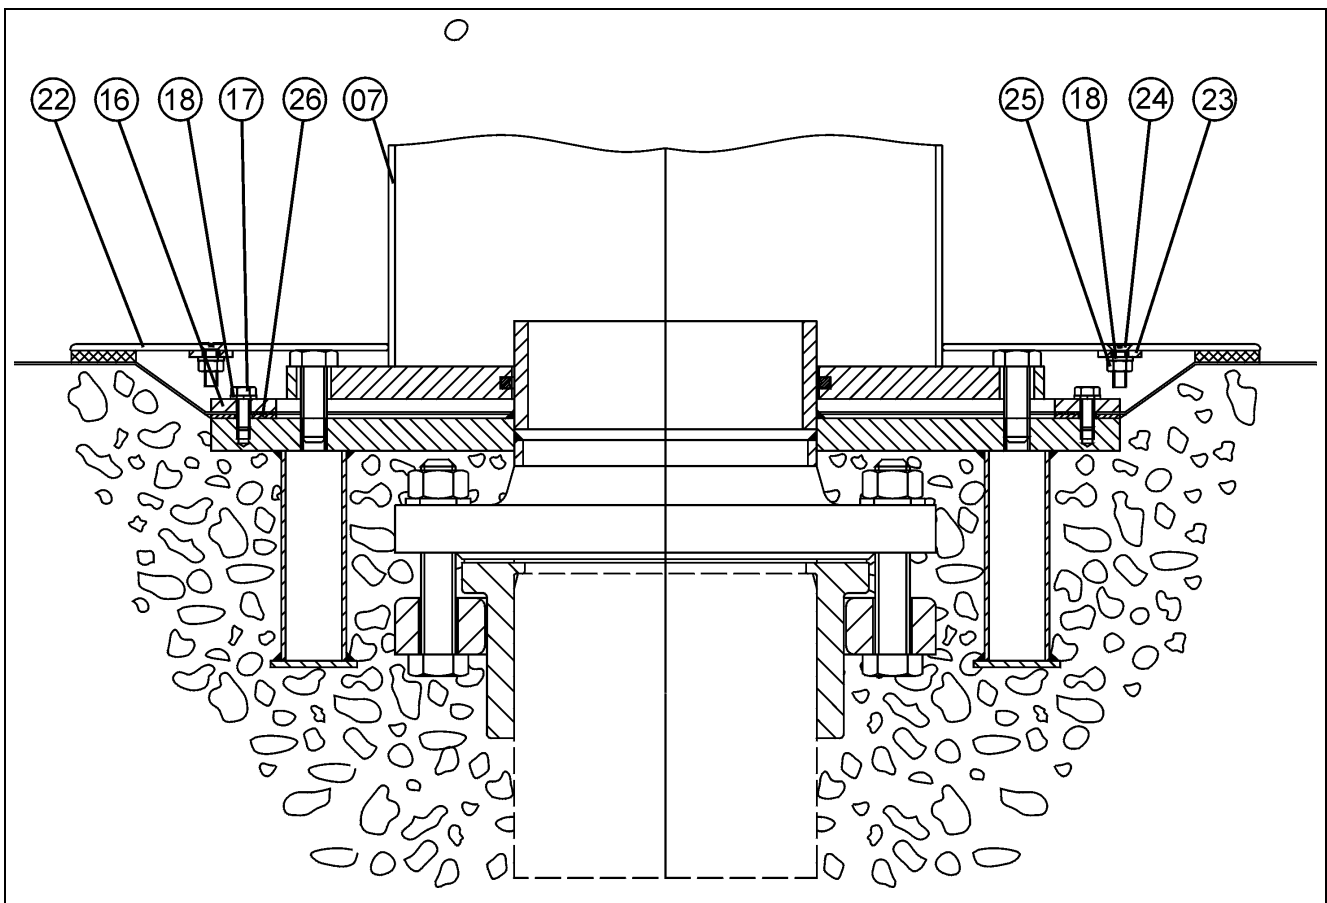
Betonbecken mit Folie / Wasserzuführung senkrecht
